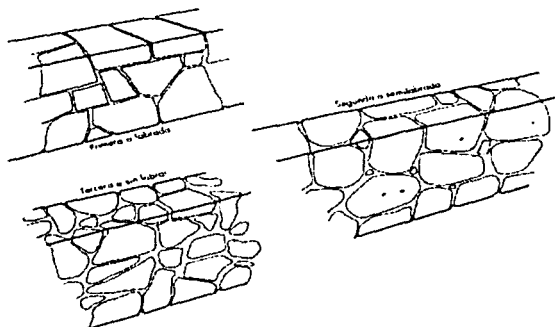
Mampostería labrada de 1ª, 2ª, y 3ª.
